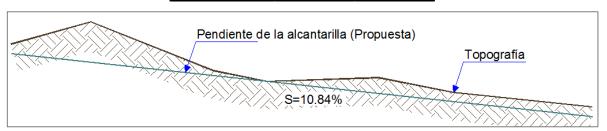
Proyección de sección transversal sobre el eje de la alcantarilla, Ilustración, 2018
